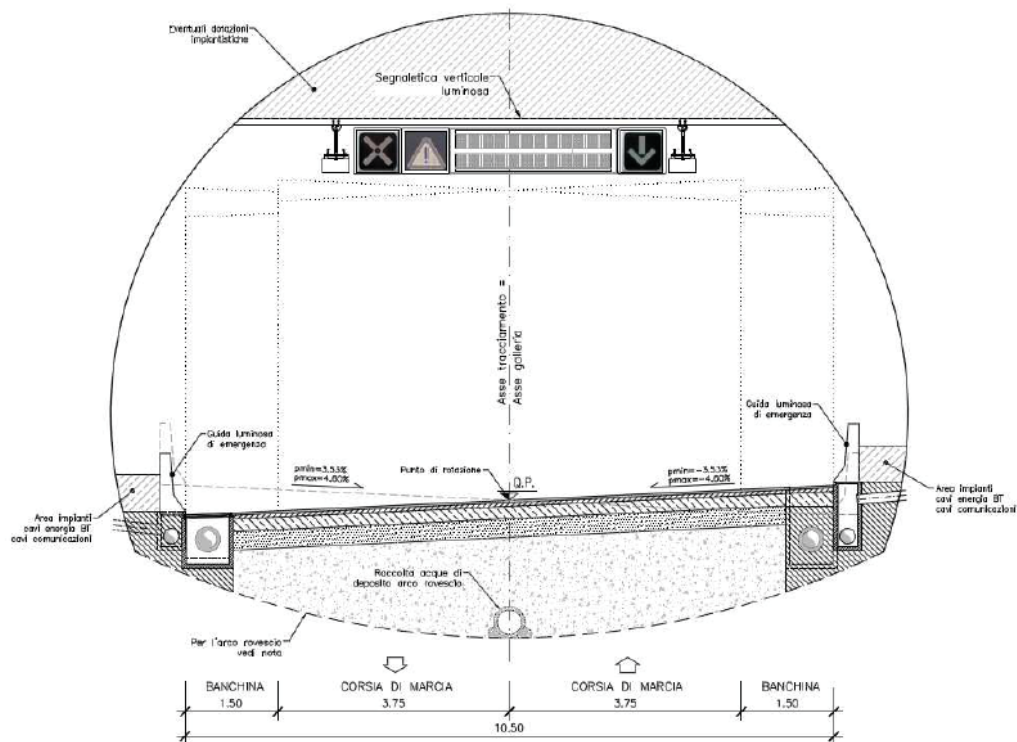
sezione tipo C1 di un ipotetico intervento con organizzazione a doppio senso in un'unica galleria
